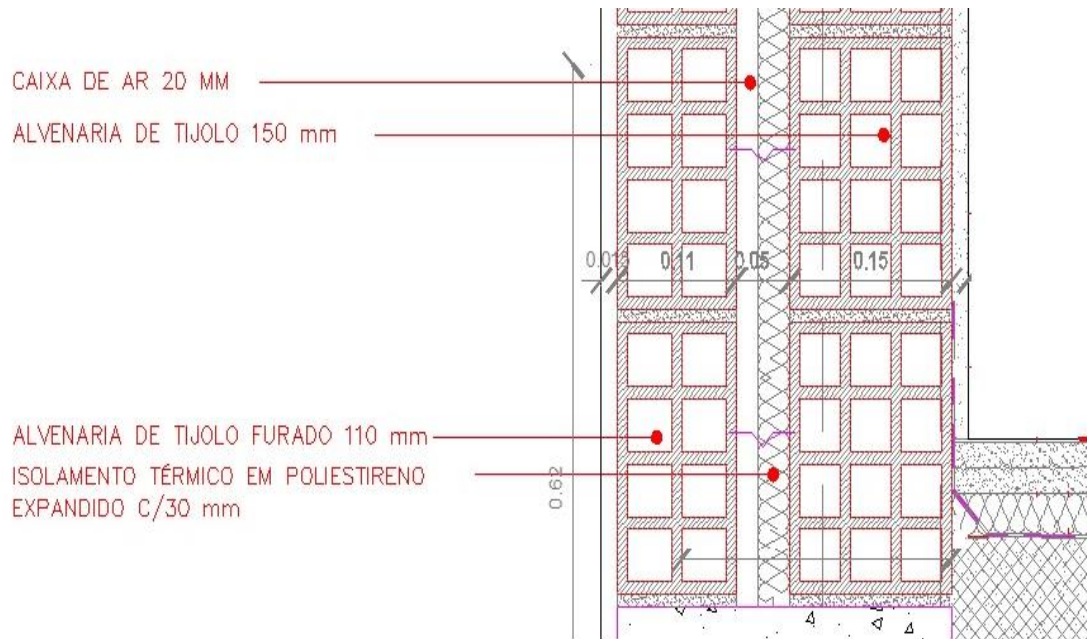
Pormenor tipo da constituição das paredes (Fonte: AutoCad CIA)
